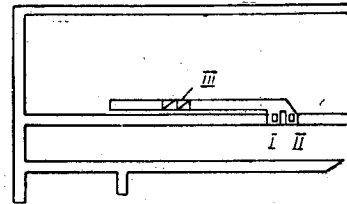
План с нанесением вентиляционных каналов и шахты
